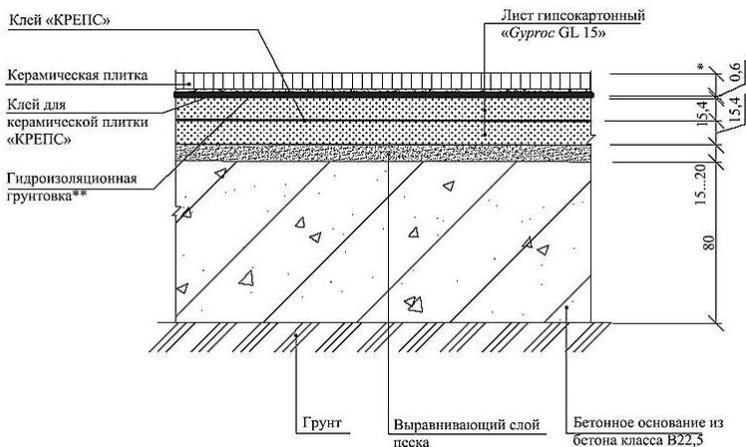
Пол на бетонном основании с покрытием из керамической плитки
